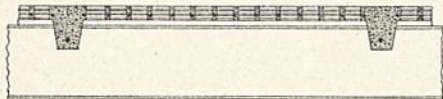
Querschnitt durch das Oberlicht mit Eisenbeton-Hilfssträger. 1:30.
